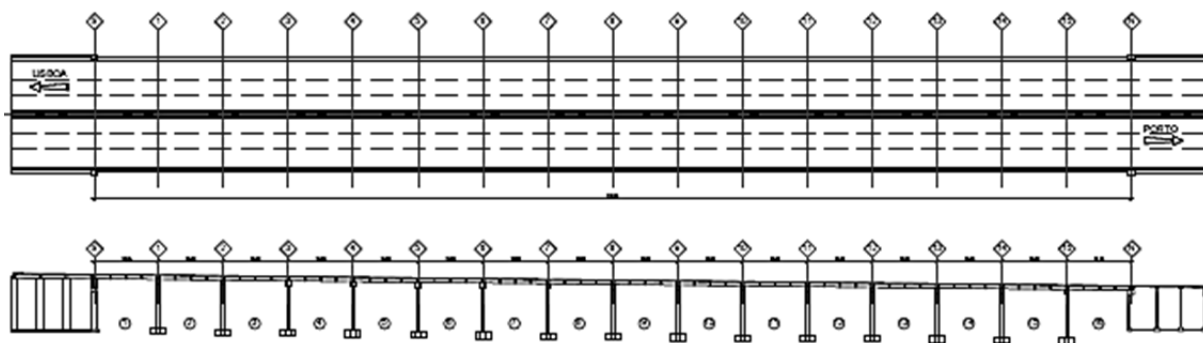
Planta e Corte Longitudinal (Brisa, 2002a).
